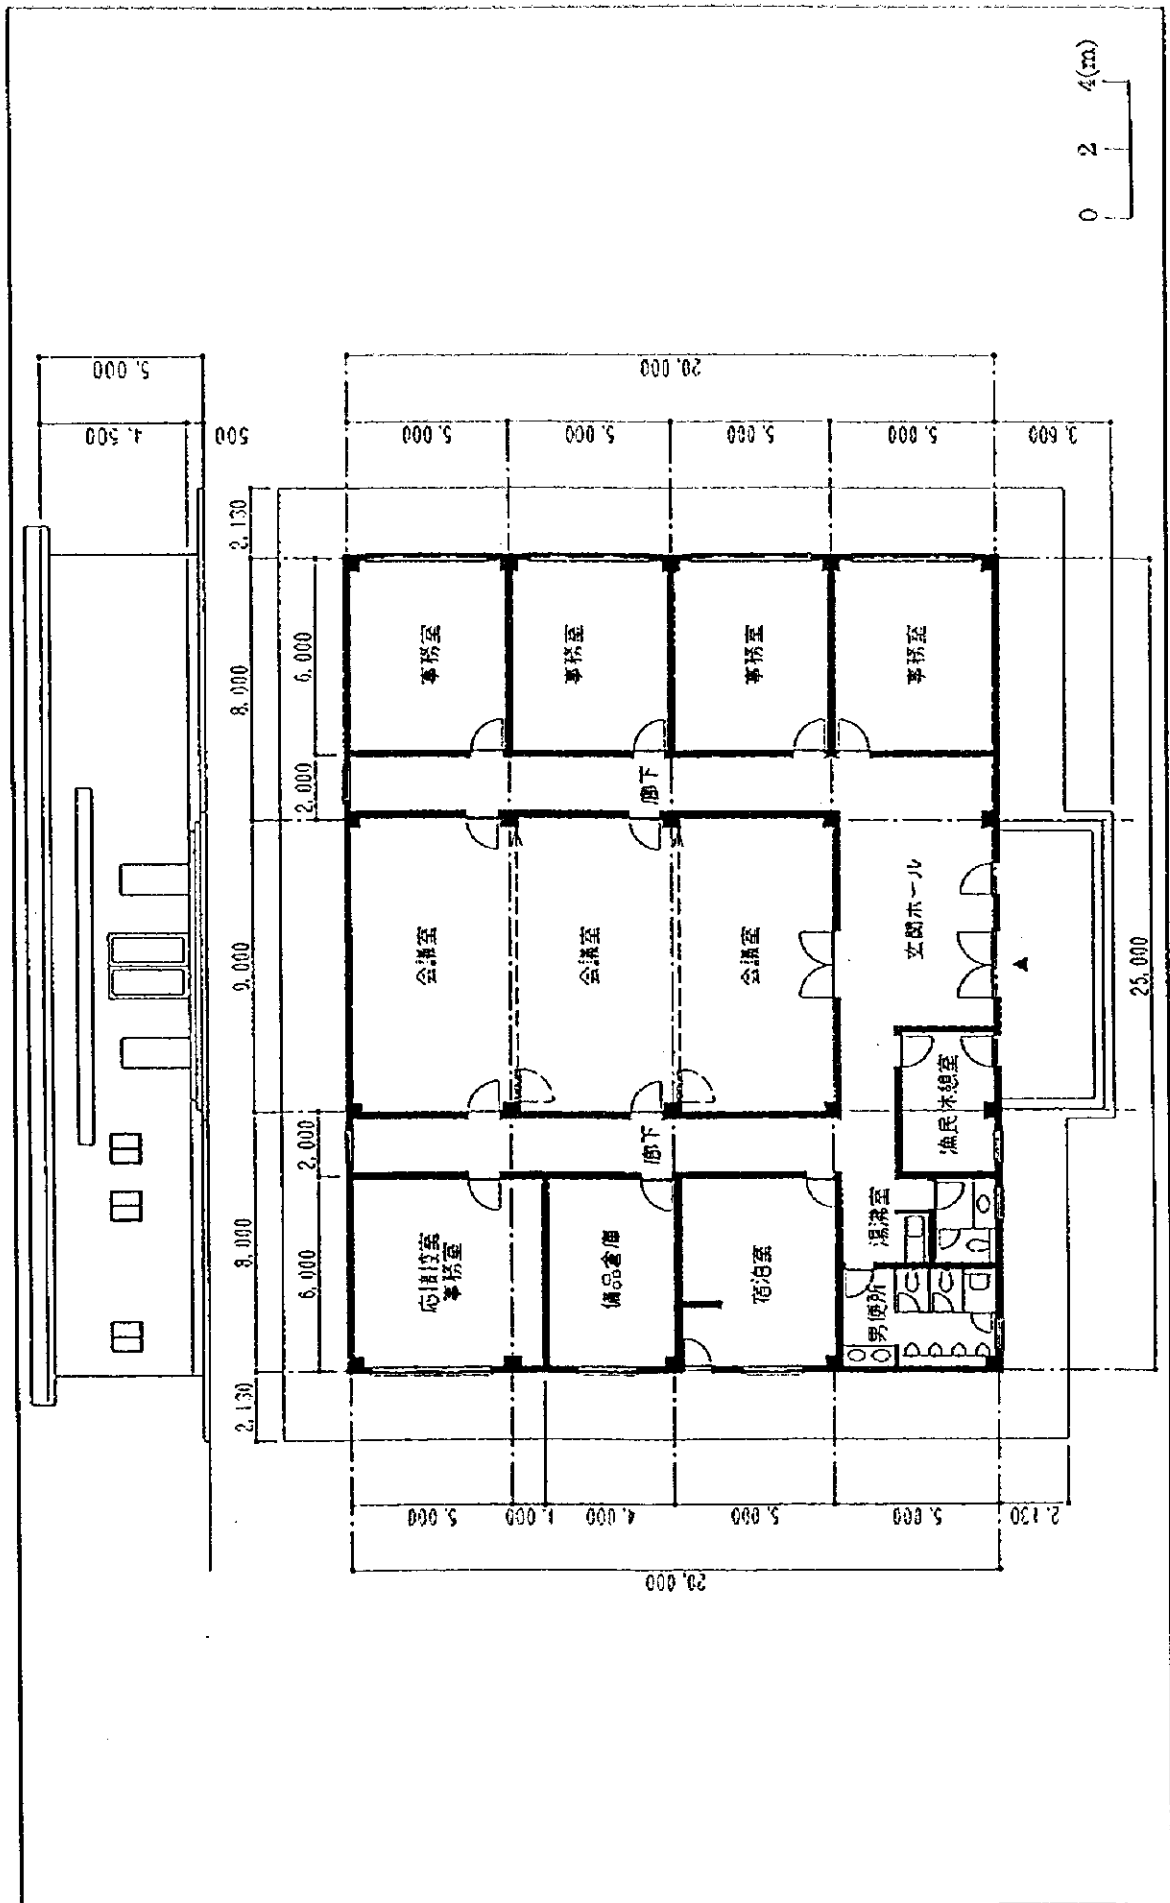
(14) 漁業活動関連棟の立面図と平面図
